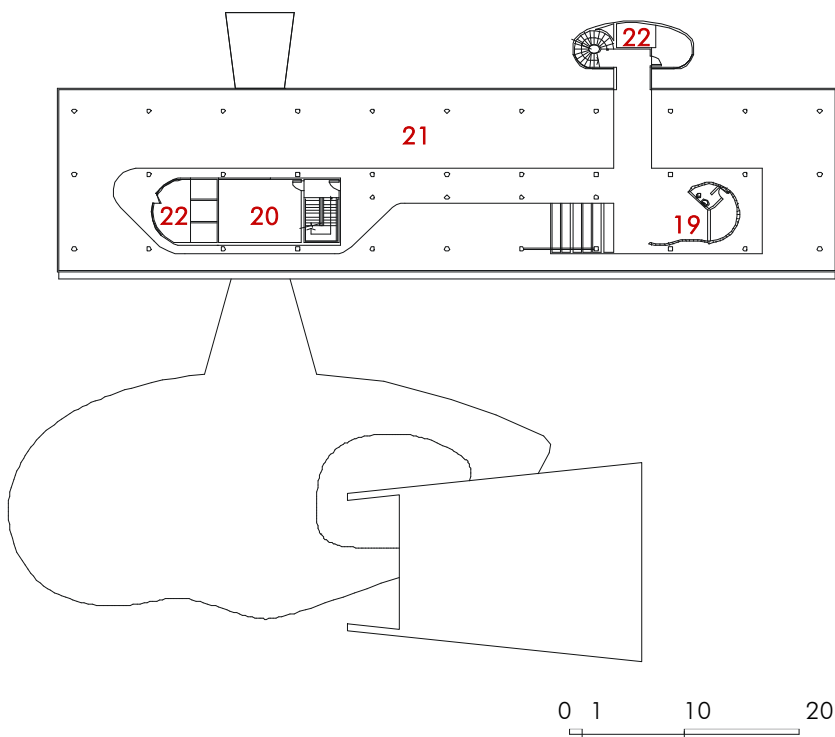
Planta do terceiro pavimento: Paço e Câmara Municipal de Bauru.
